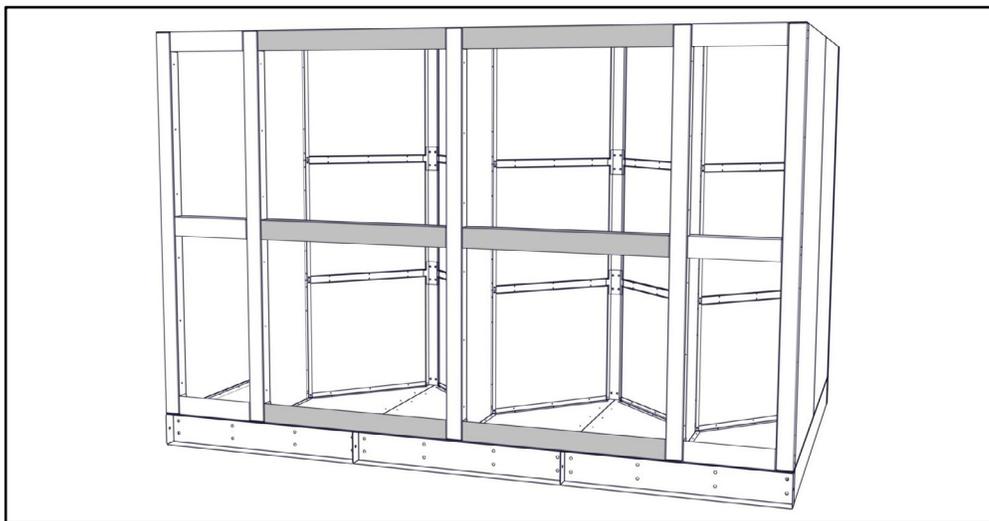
INSTALLER 2 SUPPORTS DE NOYAU
